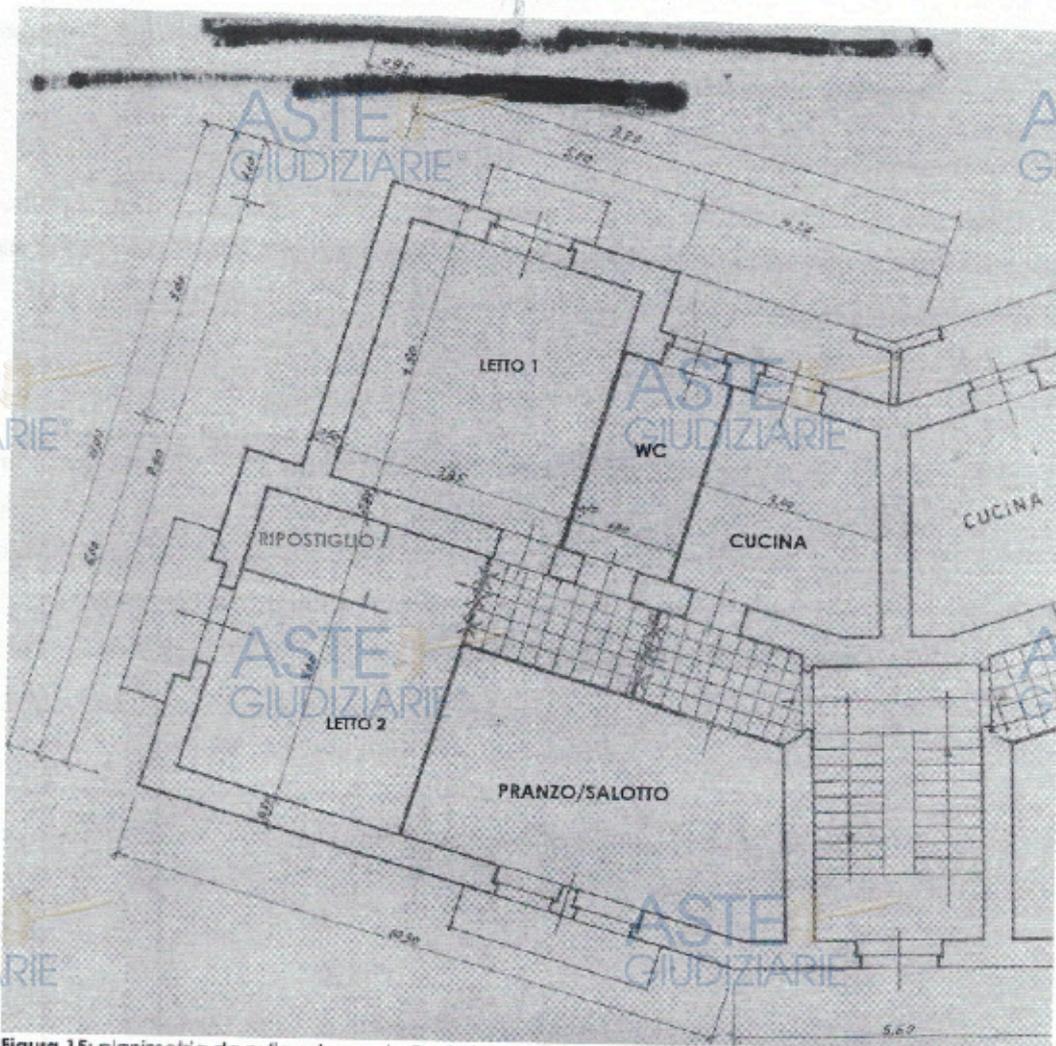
planimetria da nulla osta con indicate le modifiche rilevate
